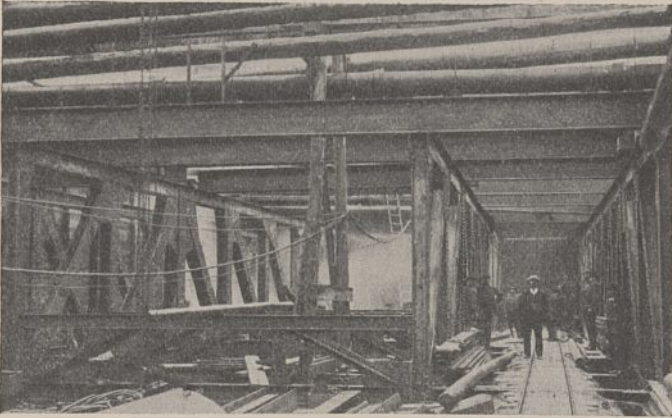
Einbau einer brückenartigen Eiseneinlage in die Tunnelwände für eine etwaige spätere Tunnelunterführung im Zuge der Grunewaldstraße.
